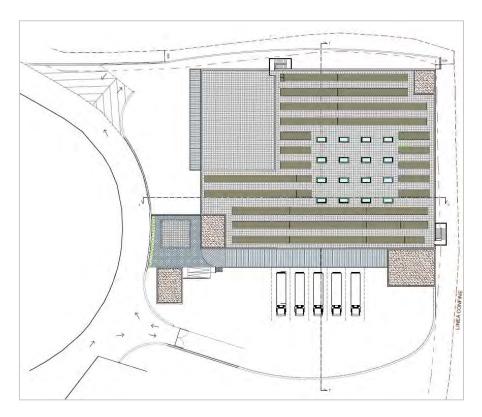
PLANIMETRIA GENERALE NUOVO MAGAZZINO
